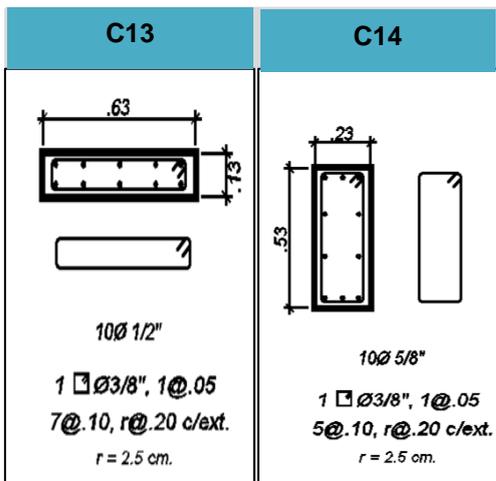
Tipo de vigas aplicadas a la IIEE Antonio Raimondi
